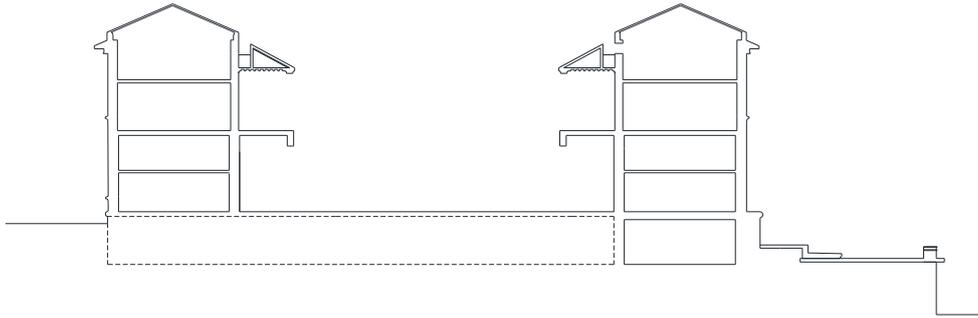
Sección del desnivel salvado entre las fachadas.
